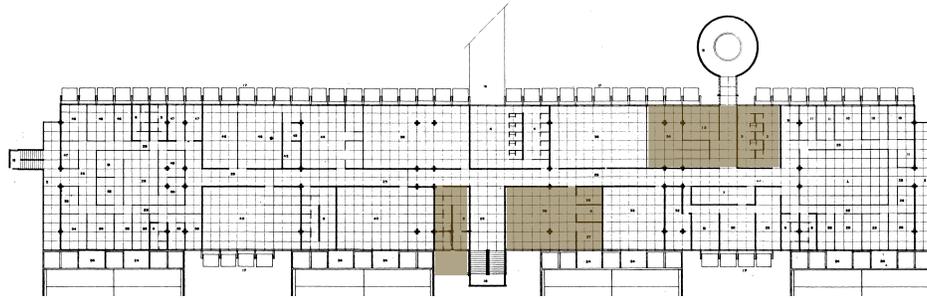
Planta do segundo pavimento, com as áreas de modificações
